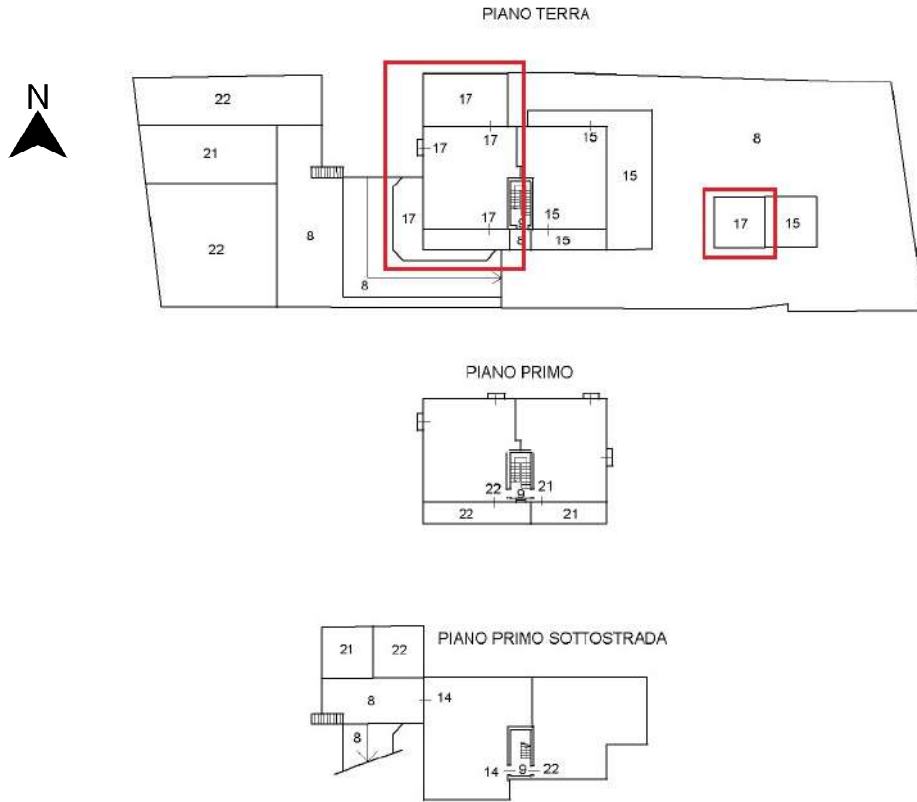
Elaborato Planimetrico con individuazione della P.la 850 sub.17
